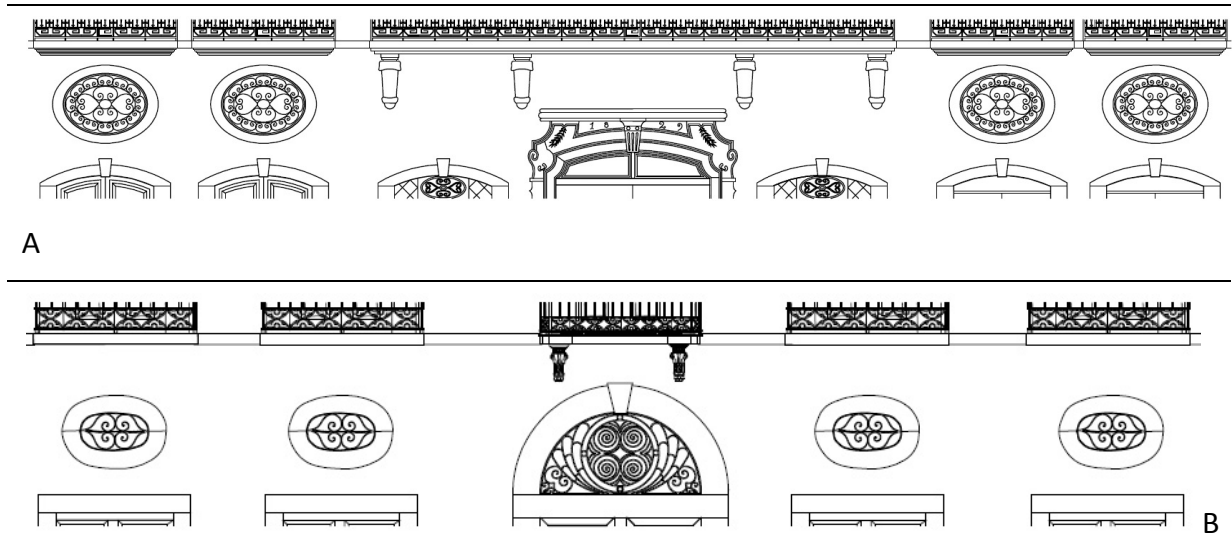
Disposição dos óculos. (A) fachada do Solar nº 46 Rua Afonso Pena, (B) fachada do Solar nº 106 Rua do Egito.
